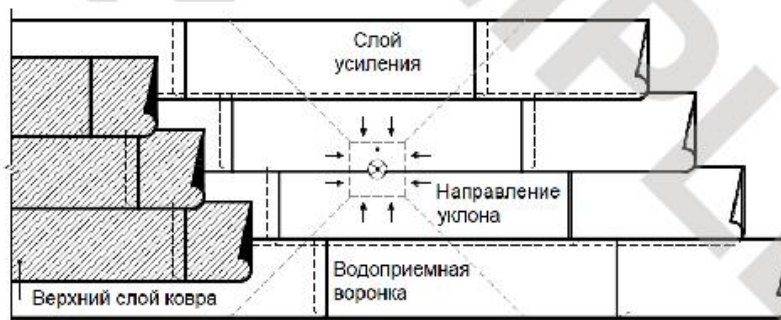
Раскладка полотнищ кровельных материалов в районе водоприемной воронки
